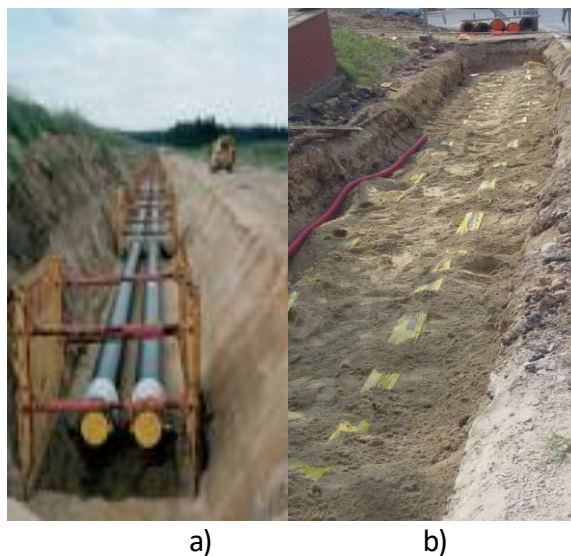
gypat e vendosur në trase, b-shiriti lajmërues mbi aksin e gypave
